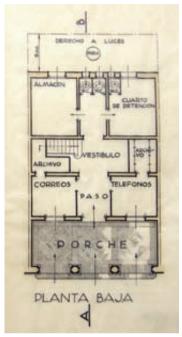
Planta baja del proyecto de ayuntamiento de Bárboles, 1932 (A.D.P.Z.).
